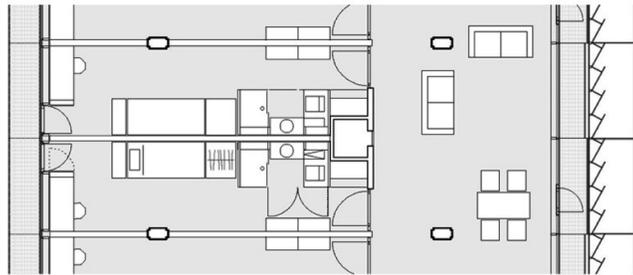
Detalhe da planta do dormitório. (Sustainable2010, 2010).
